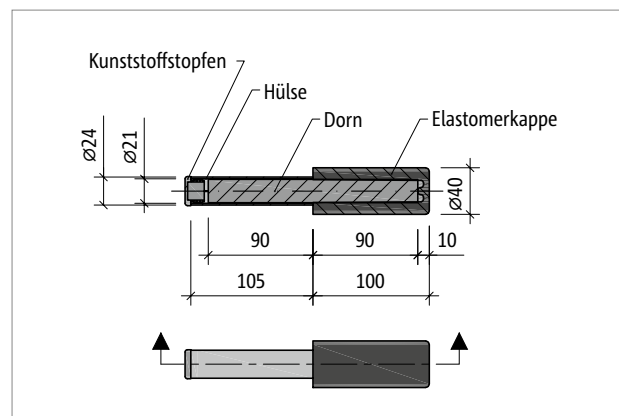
Schöck Tronsole® Typ D-H: Produktgrundriss
